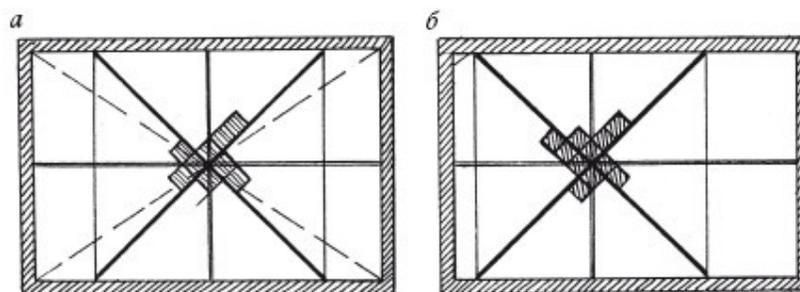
Разметка потолка перед наклеиванием плитки: а – светильник расположен точно по центру; б – светильник смещен в сторону
